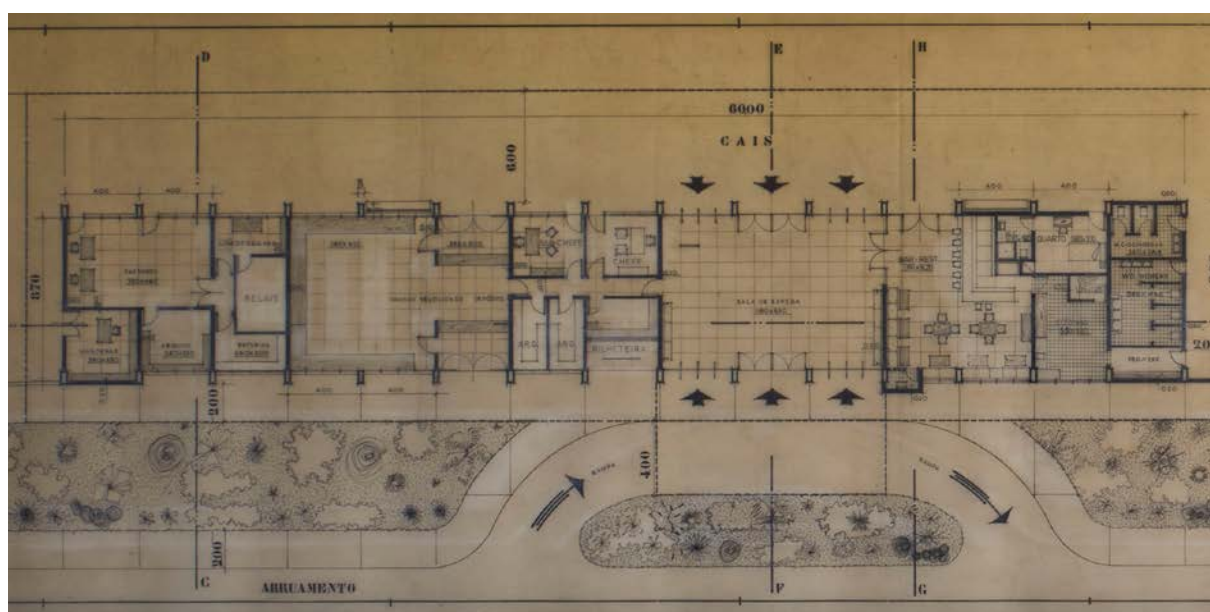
Aproximação: Estação de Vila Pery. Planta do Pavimento, Brigada de Melhoramentos dos C.F.B., 1961
